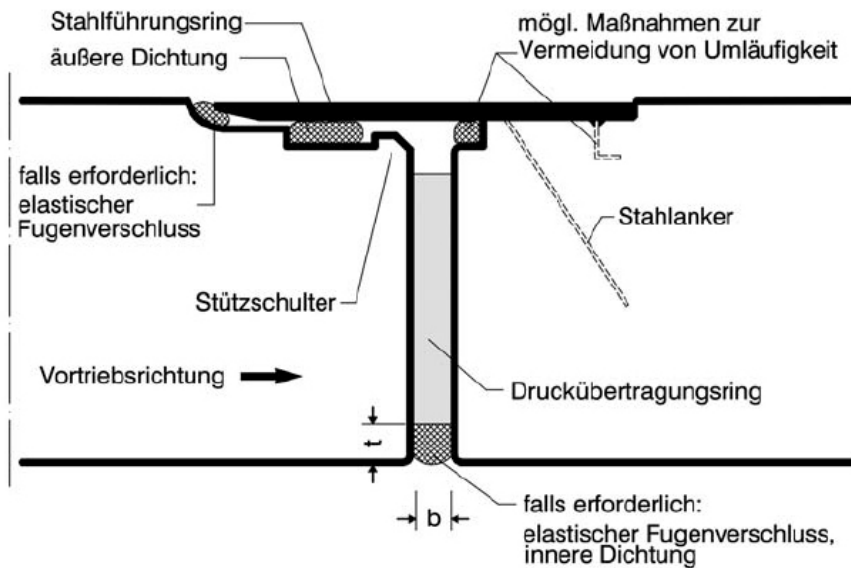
Verbindung eines Stahlbeton-Vortriebsrohres nach DWA-A 125 [1]
